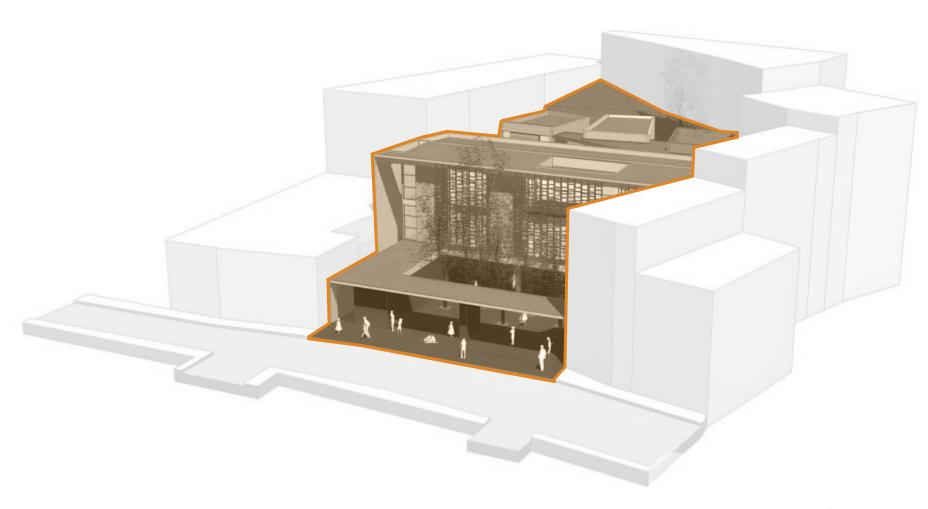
Axonometría CDI Moravias Fuente: Elaboración propia en base a planos originales Archidaily, 2025
